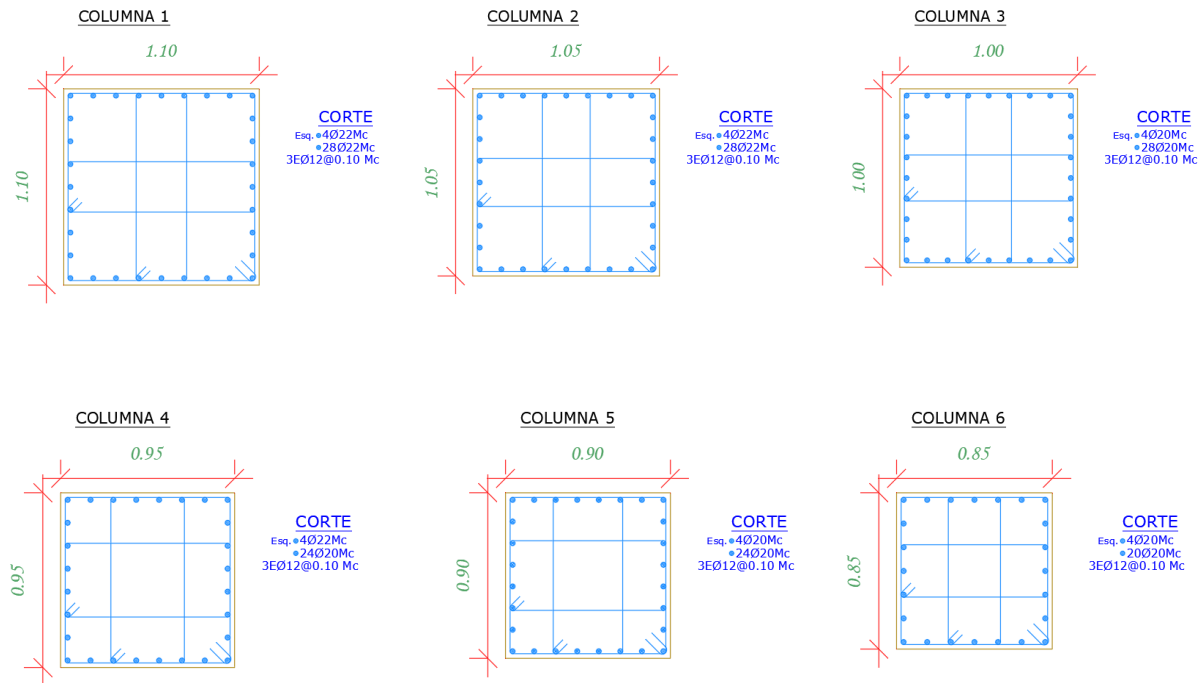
Sección transversal de la columna utilizada en un edificio de 9 pisos.
